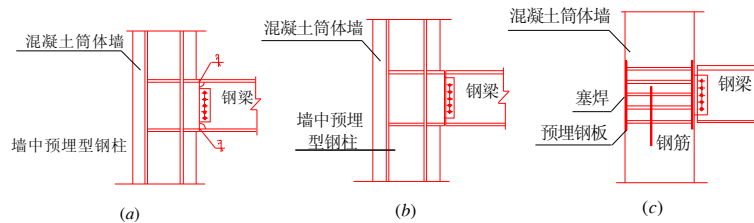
钢梁和型钢混凝土梁与钢筋混凝土筒体的连接构造示意
